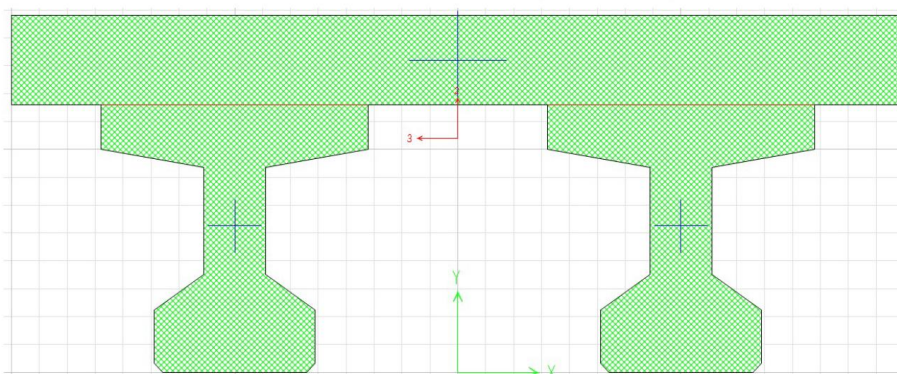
Colocación de los centros de peso propio por separado en el conjunto de la sección compuesta
